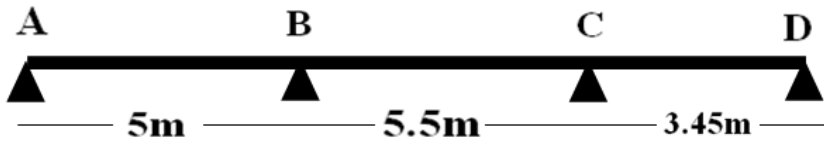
Schéma de disposition des poutrelles du plancher terrasse accessible.
